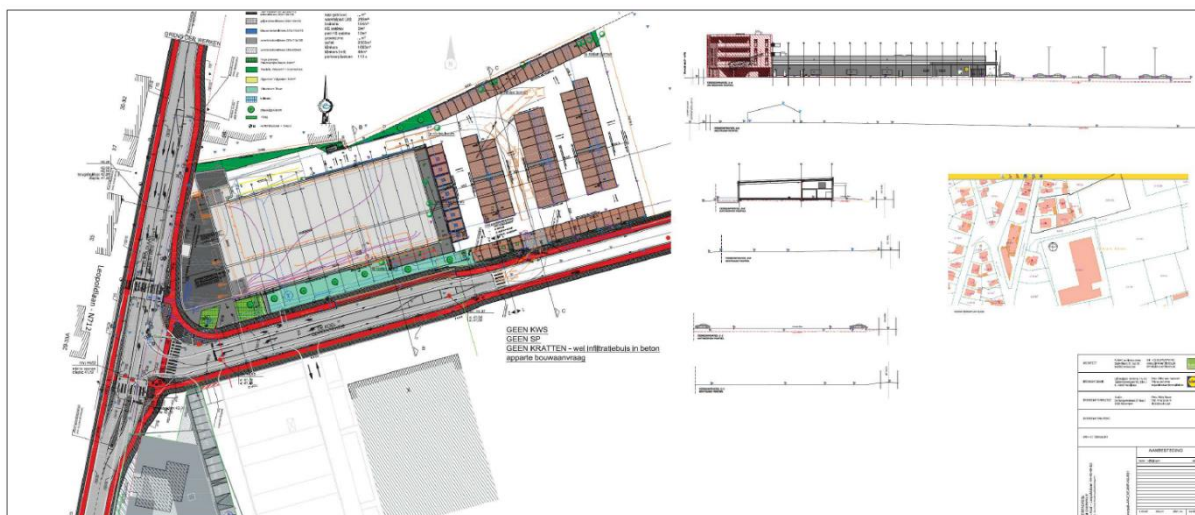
Inplantingsplan zoals aangereikt door de bouwheer en details uit het plan ©Lid'1
